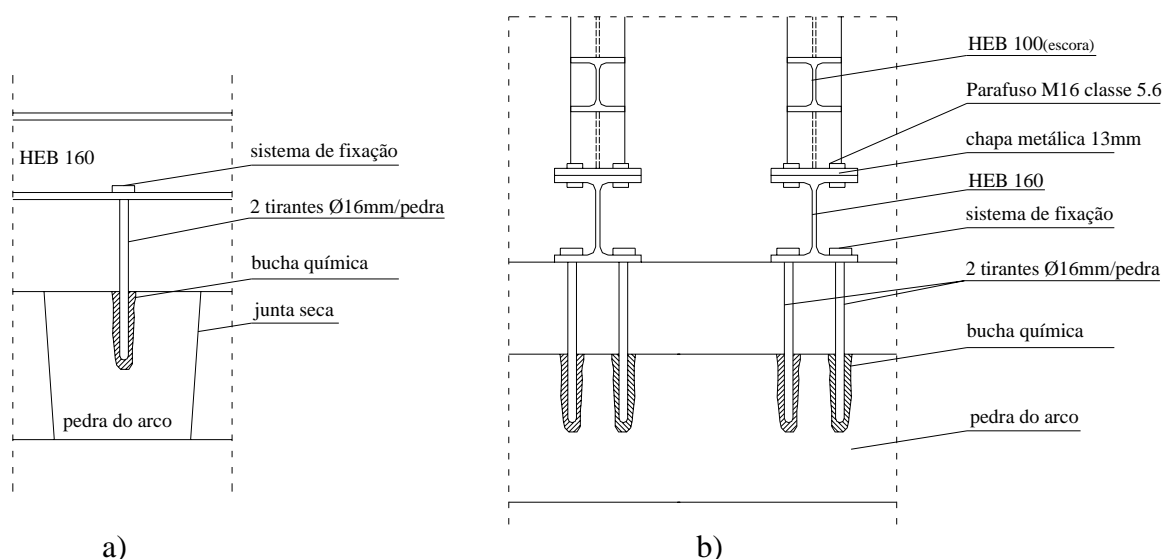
[4b]: Pormenor construtivo de sustentação das pedras do arco (sem escala)
